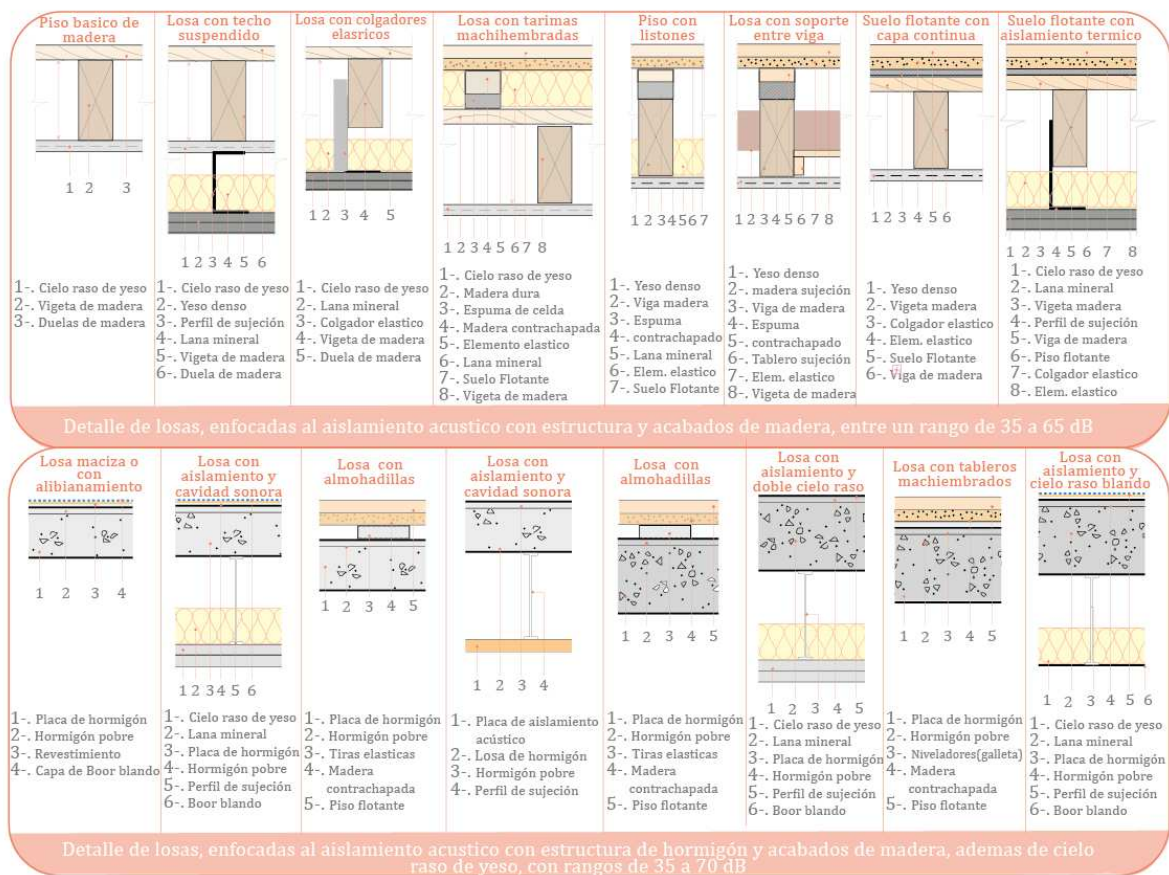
Soluciones constructivas para un adecuado confort acústico.
